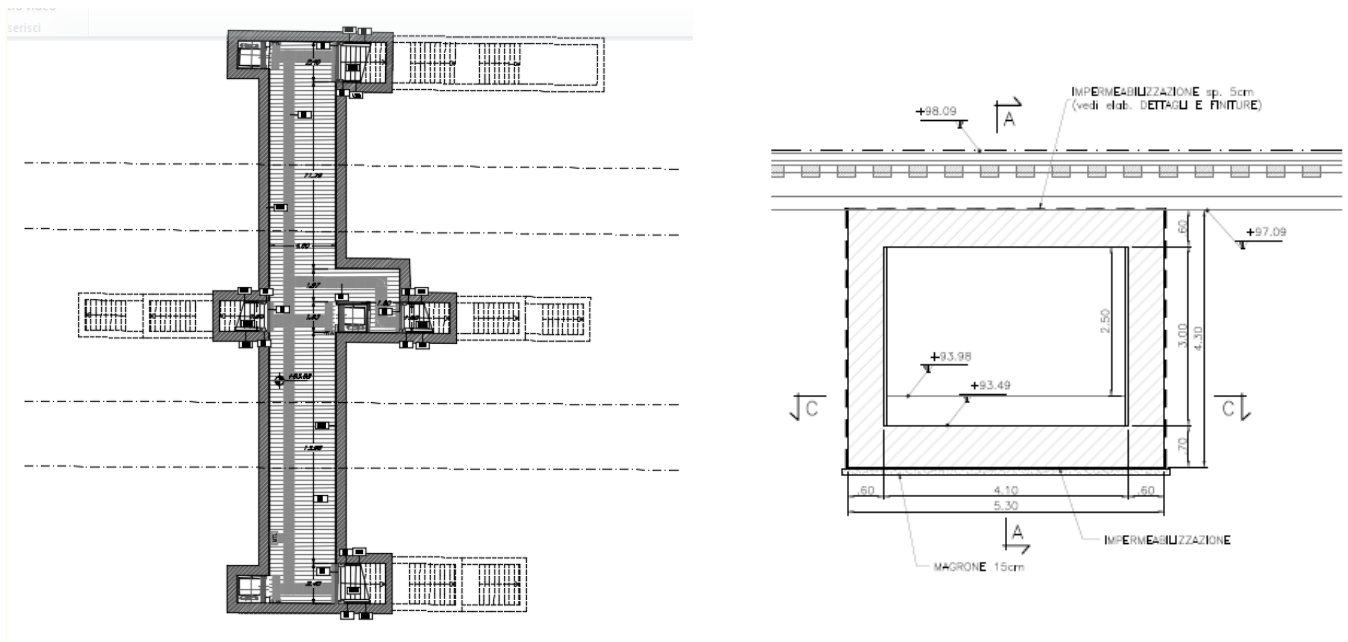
Pianta e sezione trasversale nuovo sottopasso
